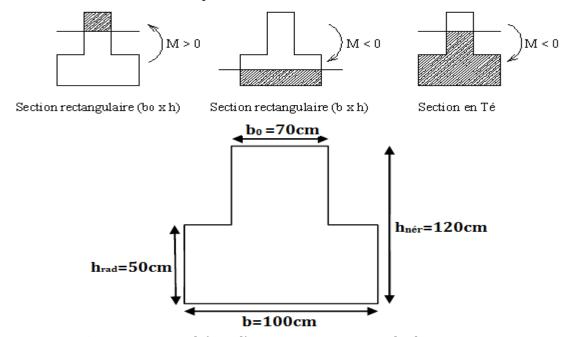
Schéma d'une coupe transversale de nervure.
